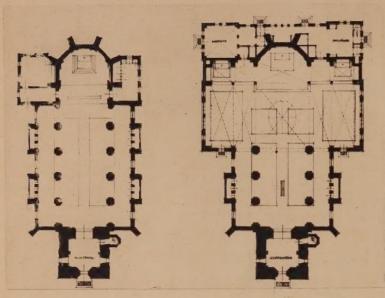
Ancien plan. Fig. 39. — Plan nouveau. Eglise de Beugen (Hollande).
